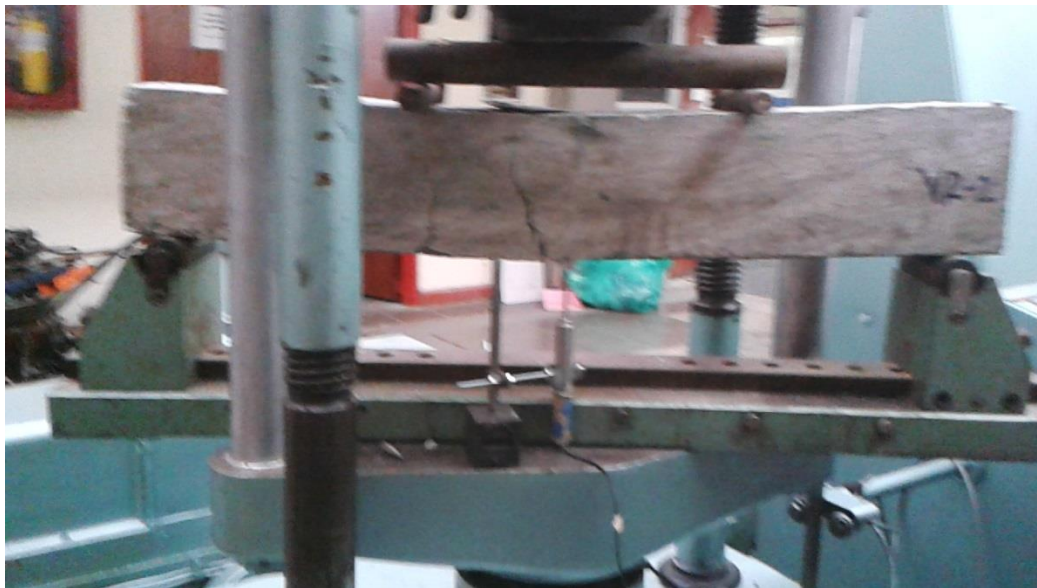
Viga VR-2 al Finalizar la prueba
